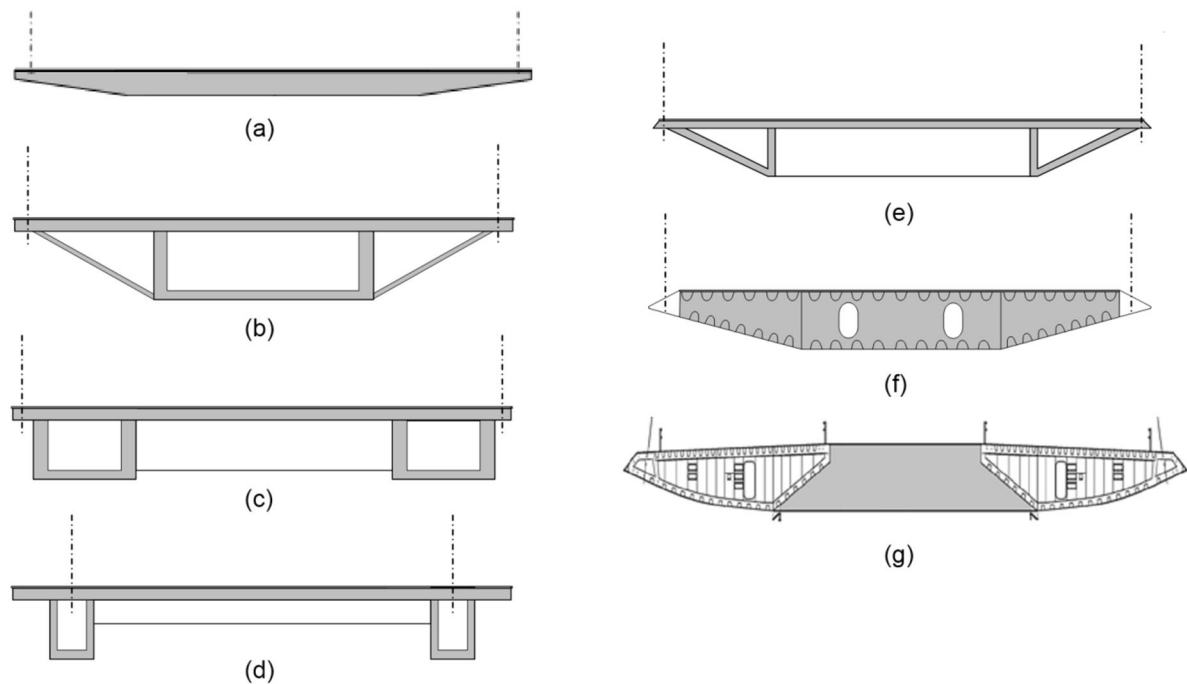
Configurações-tipo da secção transversal do tabuleiro com suspensão lateral (Calado, C.M.C., 2011)).
